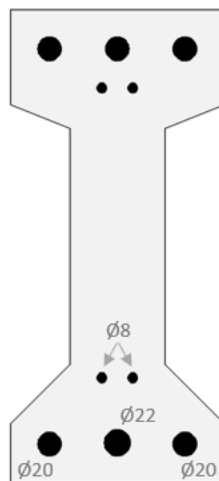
Illustrazione della posizione delle armature longitudinali nella Trave B17.
